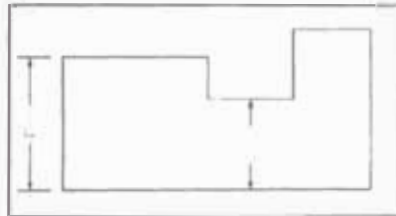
lado mayor para las plantas tipo L, T, U
